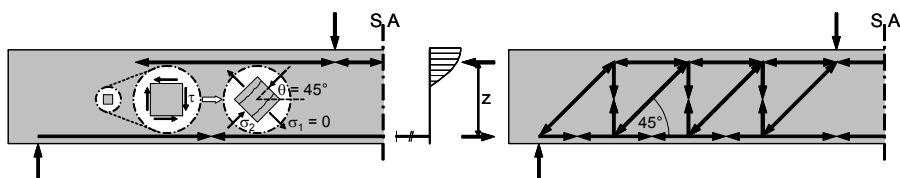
Grundlegendes 45° Fachwerkmodell von Ritter und Mörsch für biege- und schubbeanspruchte Stahlbetonbalken mit Bügeln rechtwinklig zur Stabachse.
